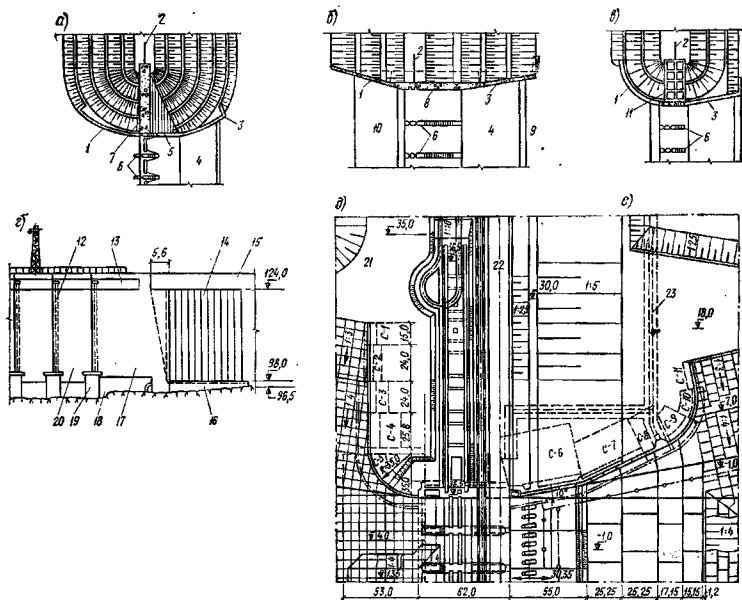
Сопряжение бетонных плотин с грунтами
